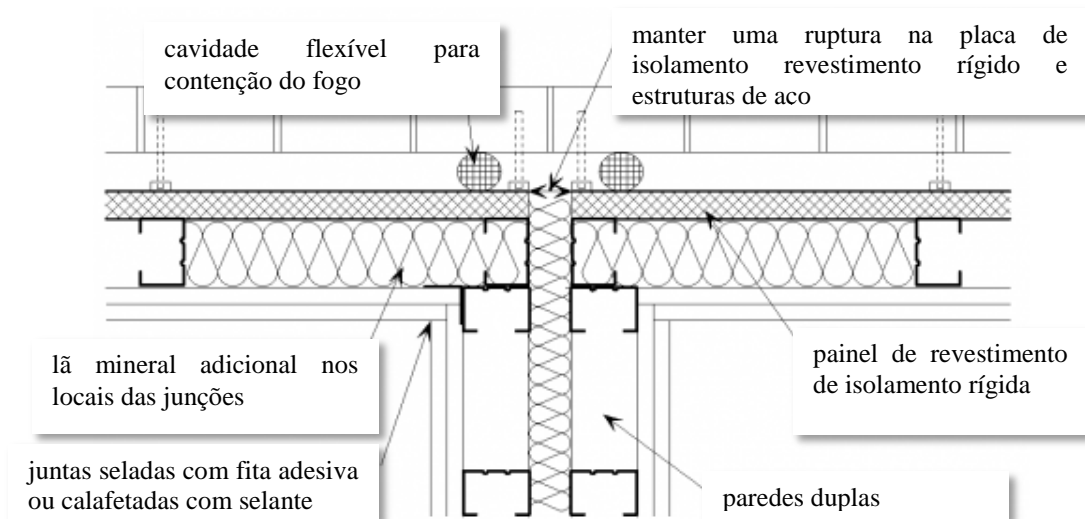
Planta esquemática do encontro de uma parede externa com uma parede divisória de ambientes. Fonte: Way e Couchman (2008).
